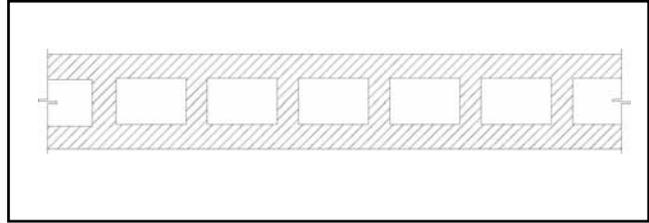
Tubería de pared estructurada corrugada de doble pared
